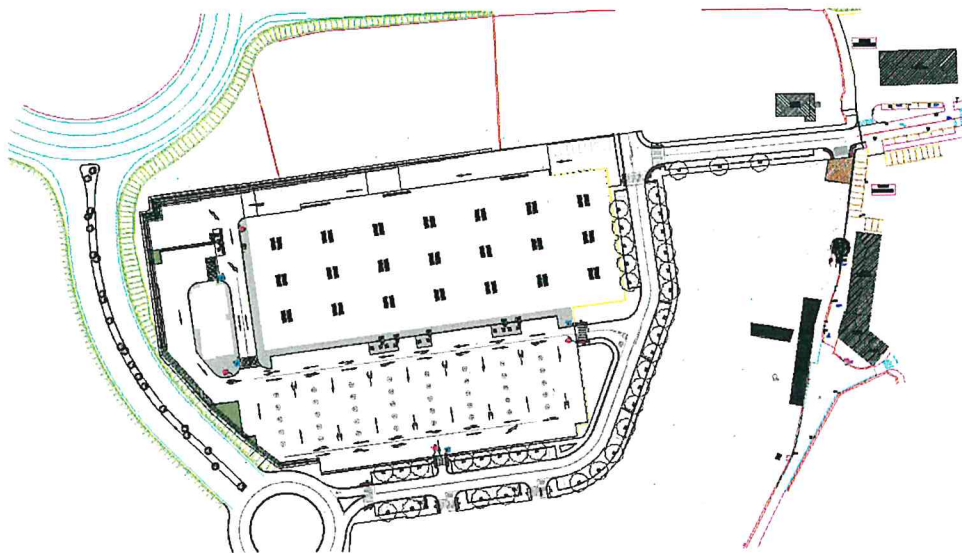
Esquema de implantação do retail park e do novo arruamento
